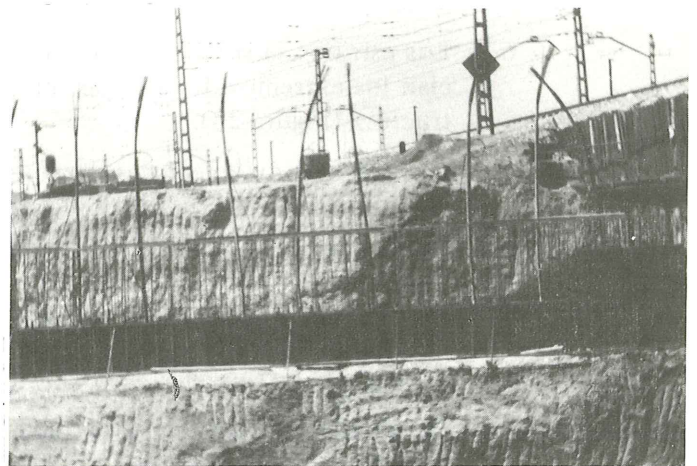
Estribo lado Madrid. Cables de anclaje del tablero.
